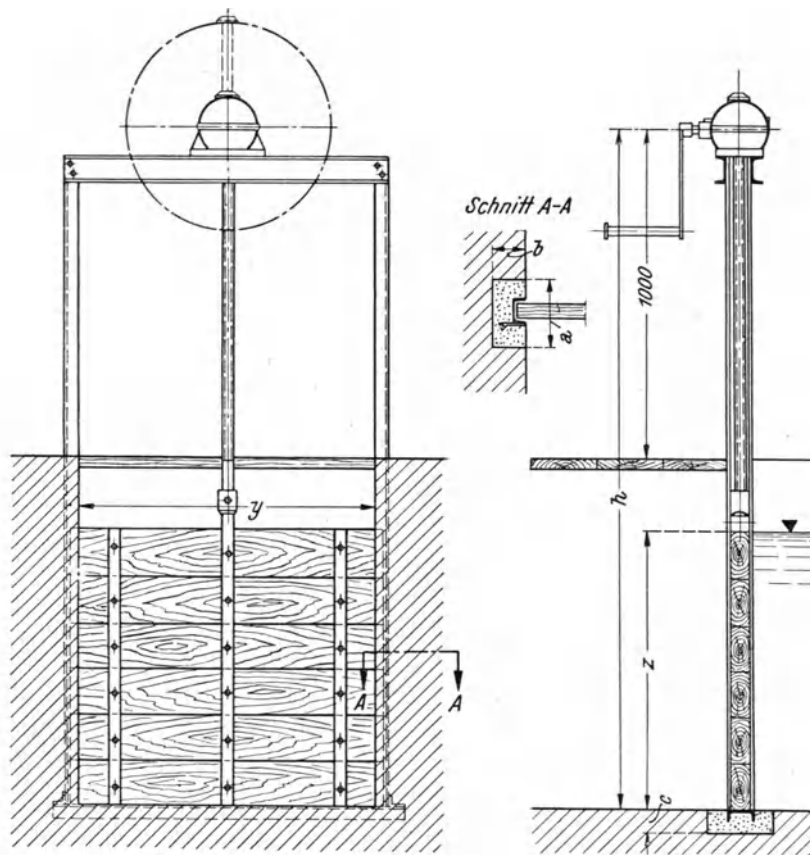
Holzschütze in Stahlführungsrahmen mit Schraubenspindelaufhängung und gekapseltem Kegelgetriebe (PAN 322).
